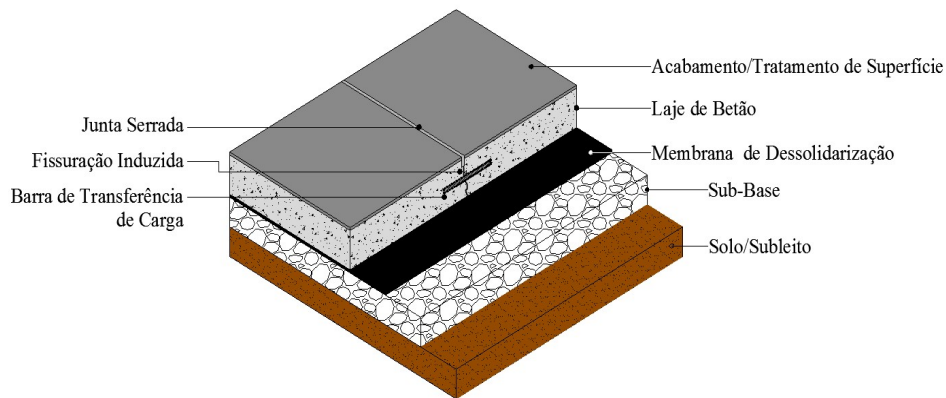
Constituição de um pavimento industrial corrente (Adaptado de Cristelli, R., 2010)
